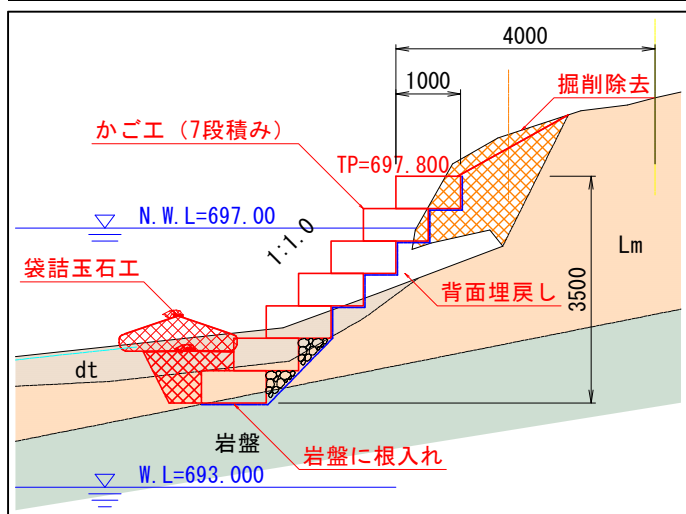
侵食防止対策工の標準断面図 Standard cross section of the erosion prevention work
